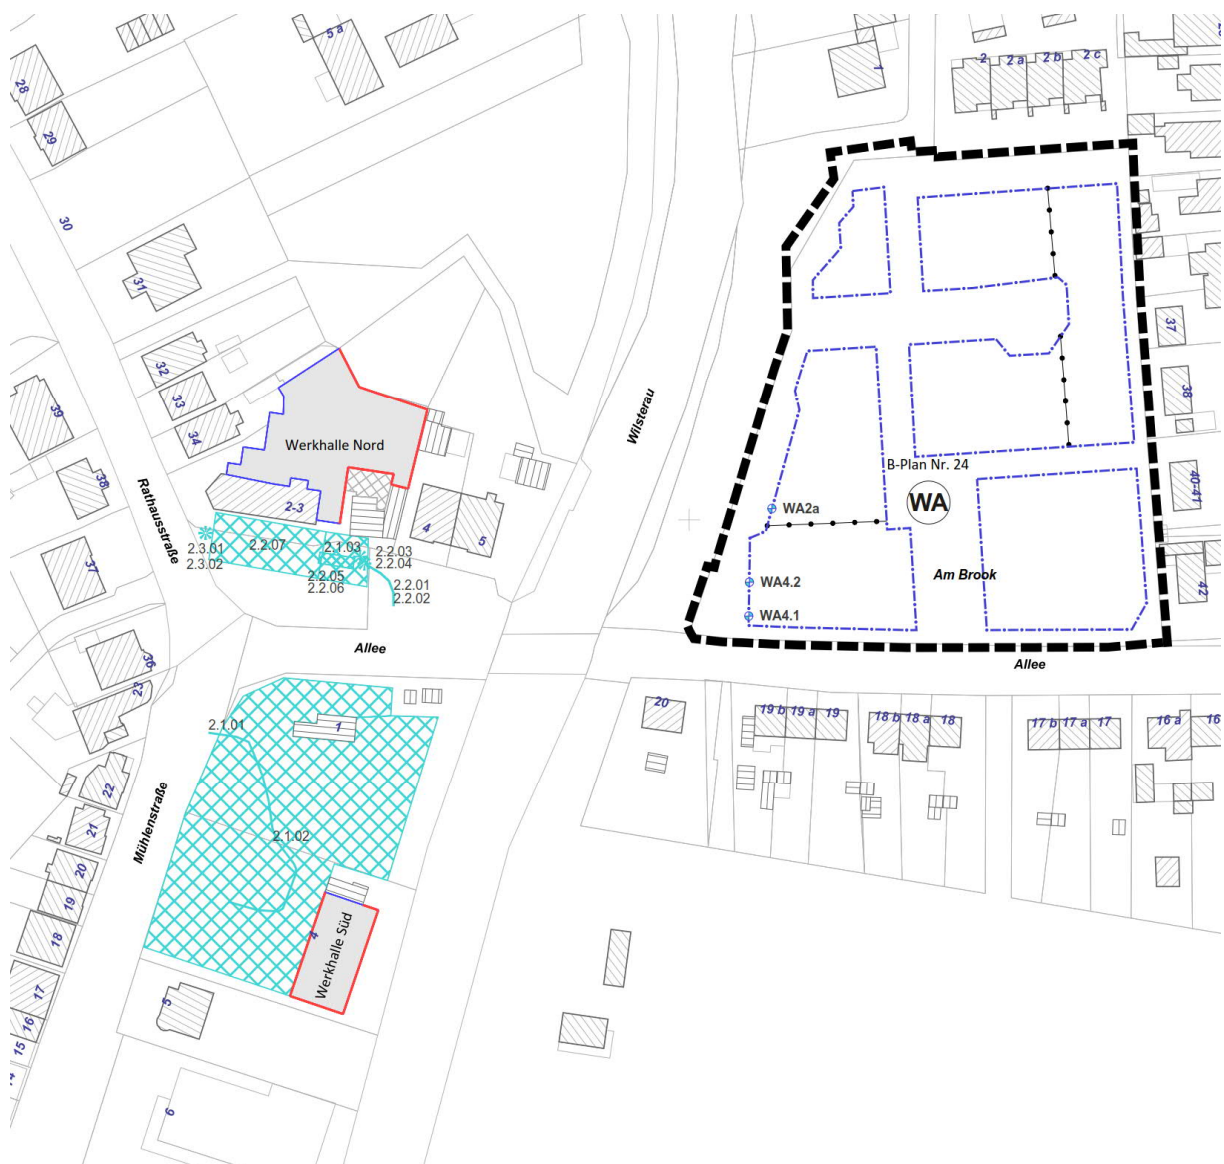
Lageplan der Schallquellen (Gewerbelärm)³
